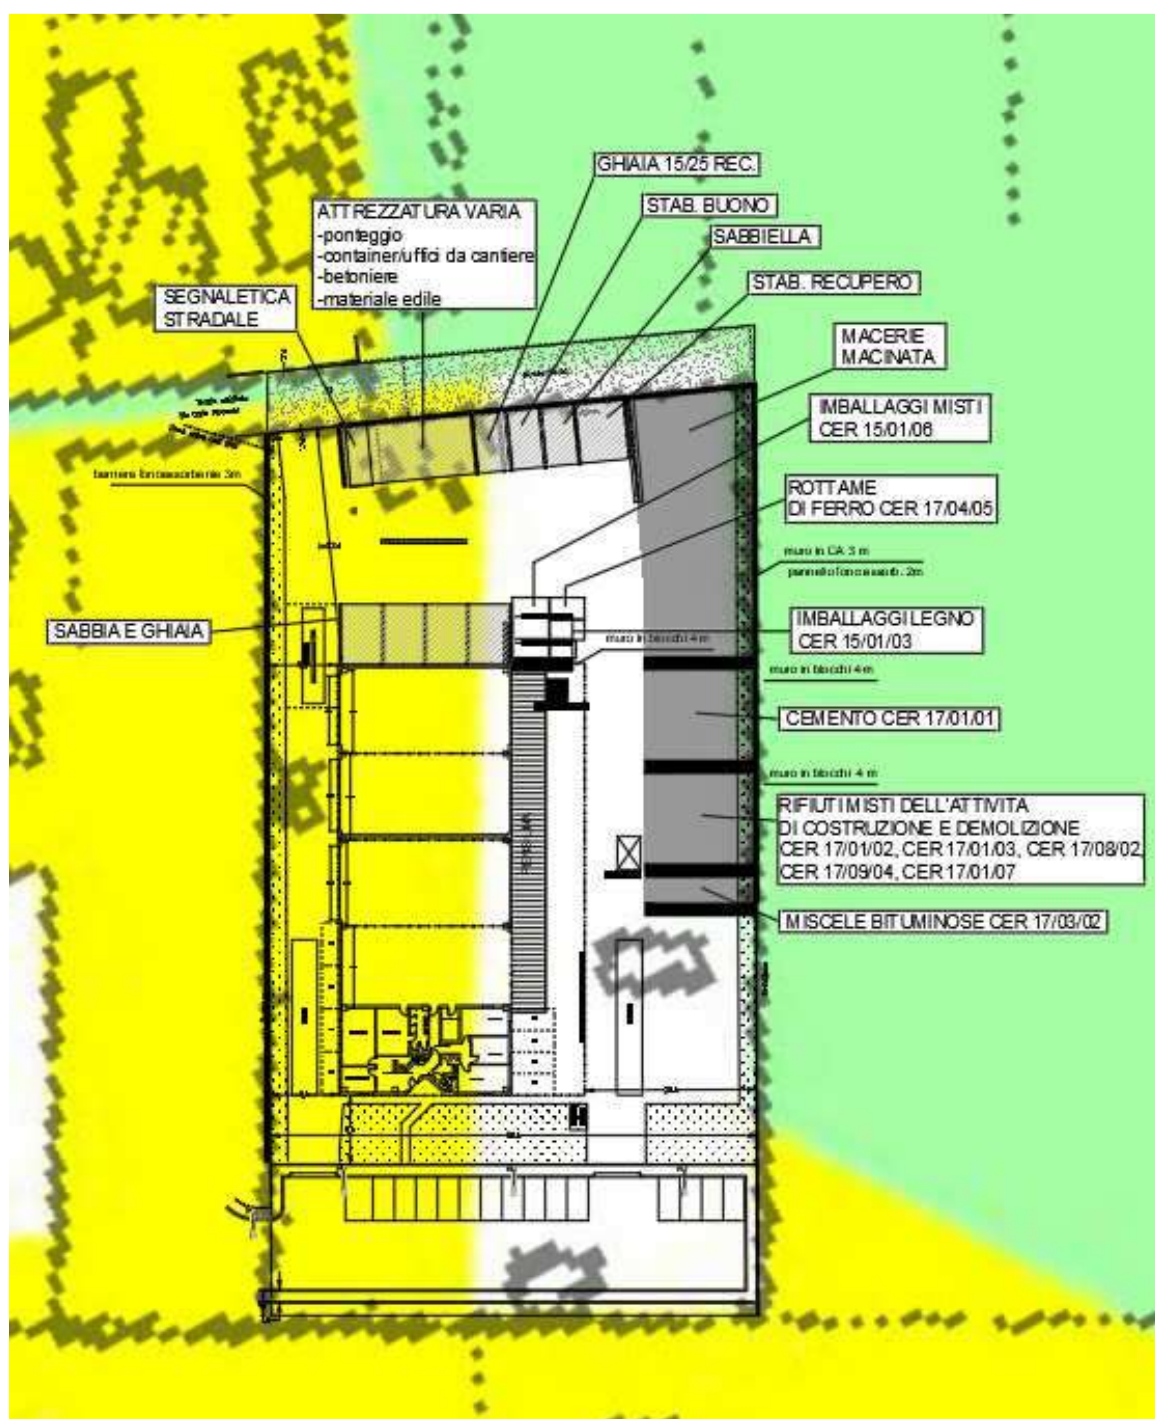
Dettaglio tav. 5A – sovrapposizione con layout di progetto ed individuazione aree di attività recupero rifiuti
